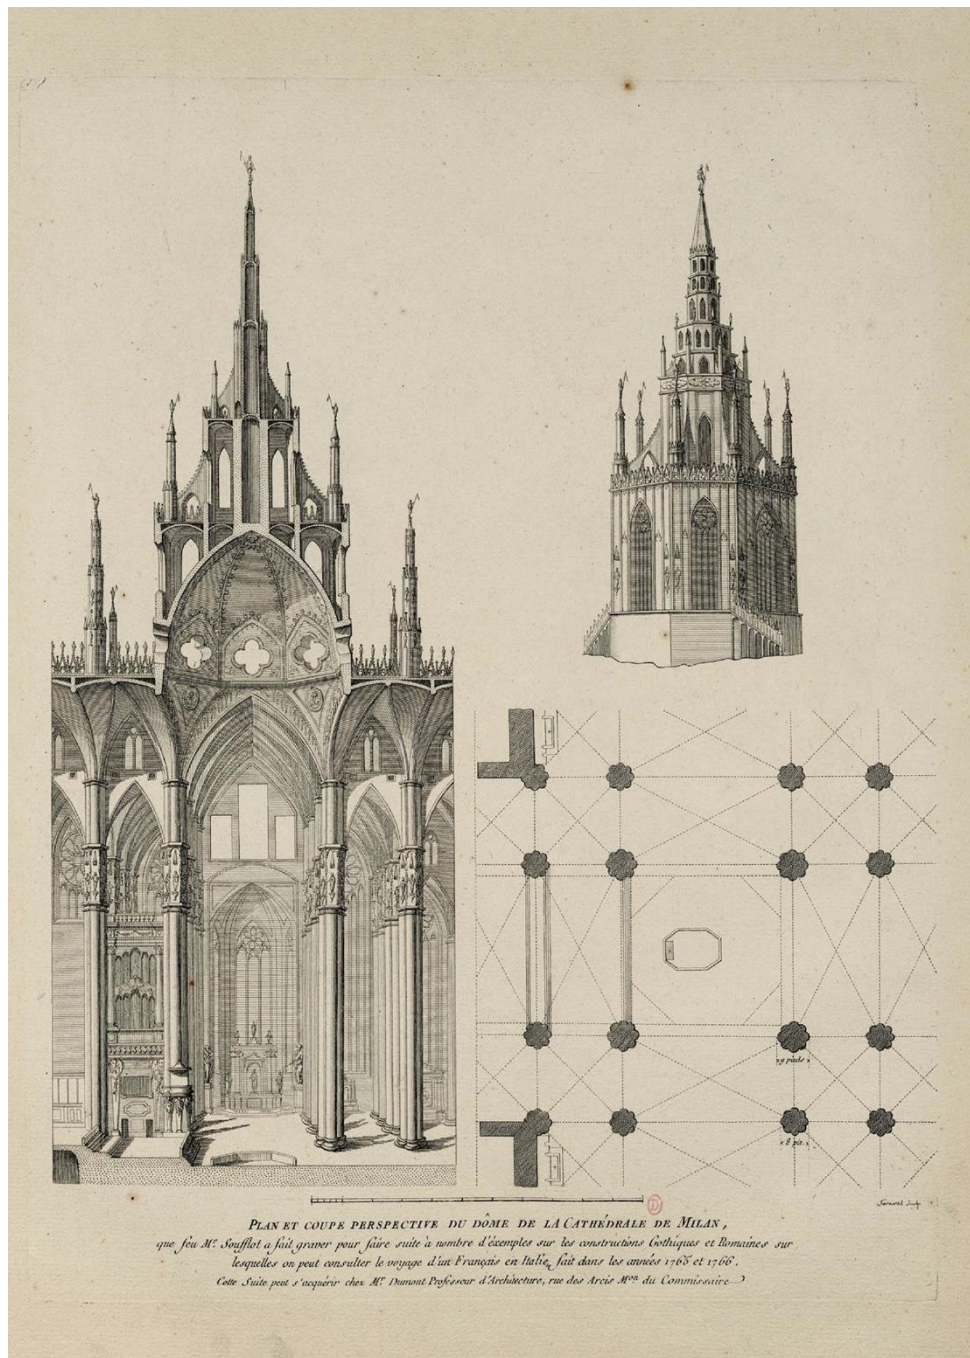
13 : Dôme de Milan, coupe perspective, plan, détail de la lanterne.
